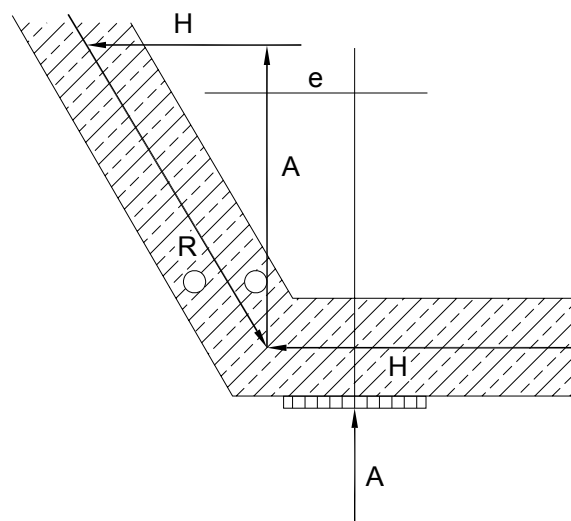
2 – Reacción excéntrica en las placas de lanzamiento
